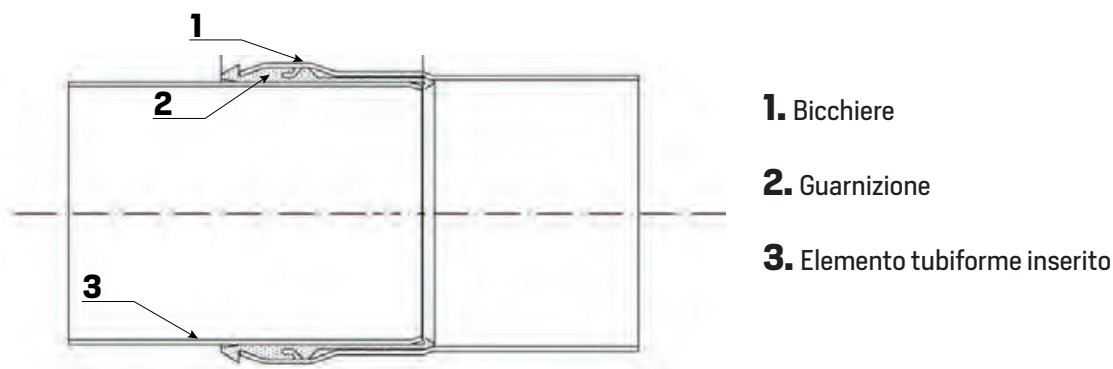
Sezione di un raccordo accoppiato ad una tubazione con interposizione di guarnizione “alta” tipo 826/GV
